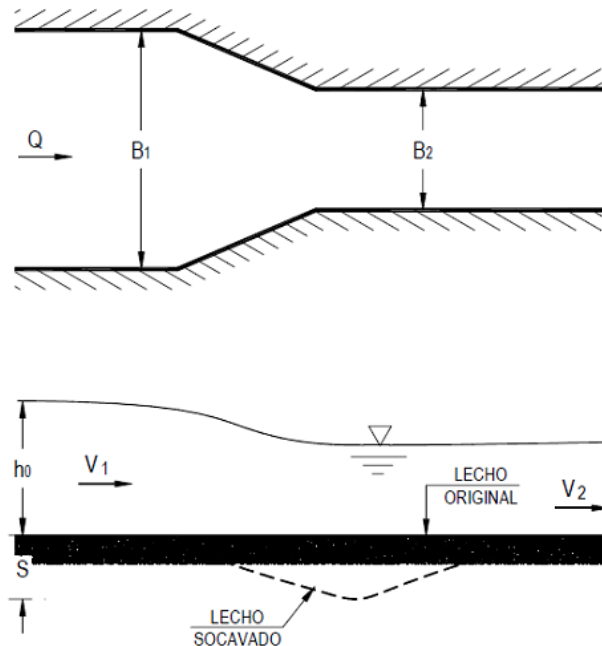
Cálculo de la socavación vista en planta y perfil
